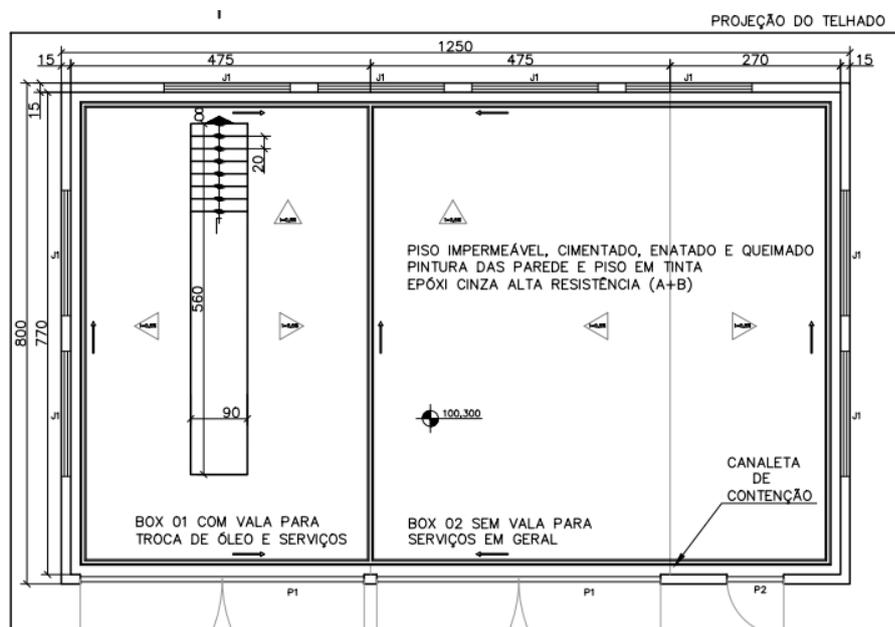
Recorte da planta da oficina mecânica. Fonte: Informação complementar.
